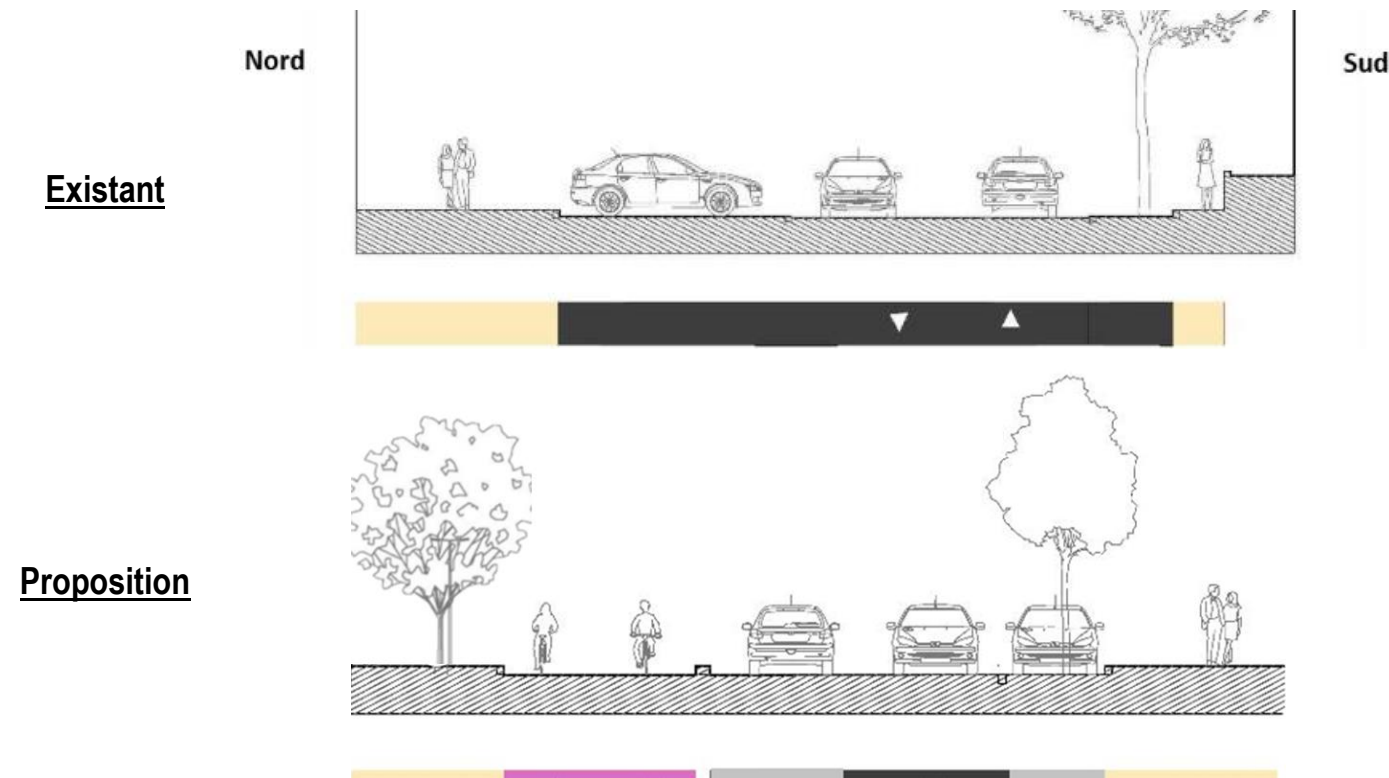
Coupes de l'existant et du projet secteur Hachette-Dauphiné, Section a : Rue Hachette
